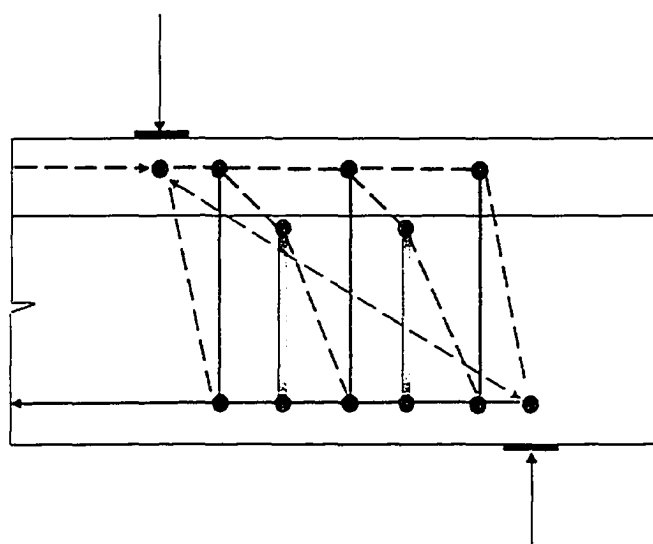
Exemple d'application du modèle des bielles et tirants appliqué aux poutres profondes renforcées de FRP
